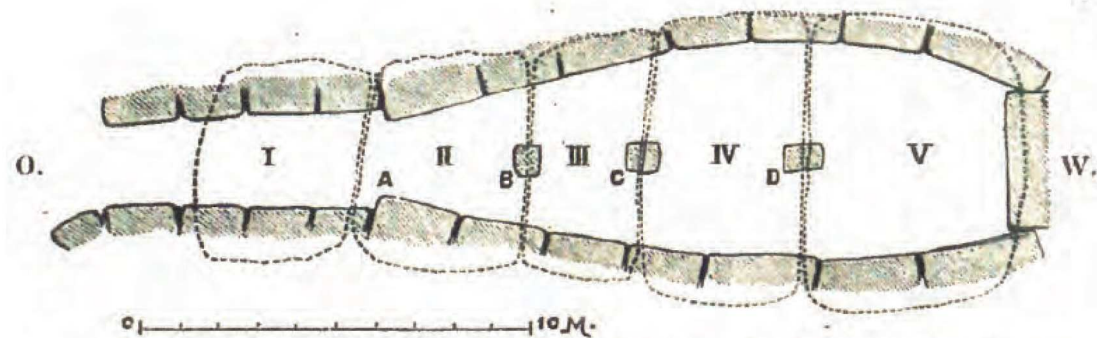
a. Grundriss eines Grabes bei Antequera, südöstliches Spanien. Nach den vom Verf. 1879 vorgenommenen Messungen.
